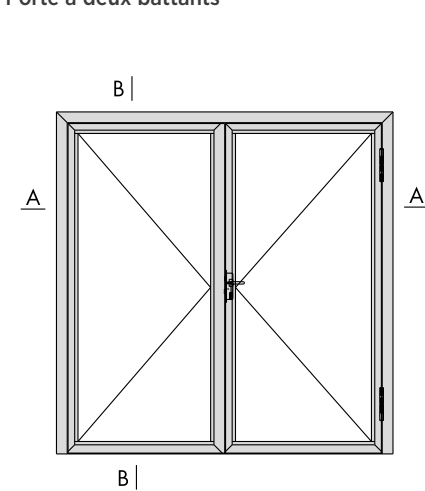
Porte profilée coupe-feu en acier, système Jansen.
